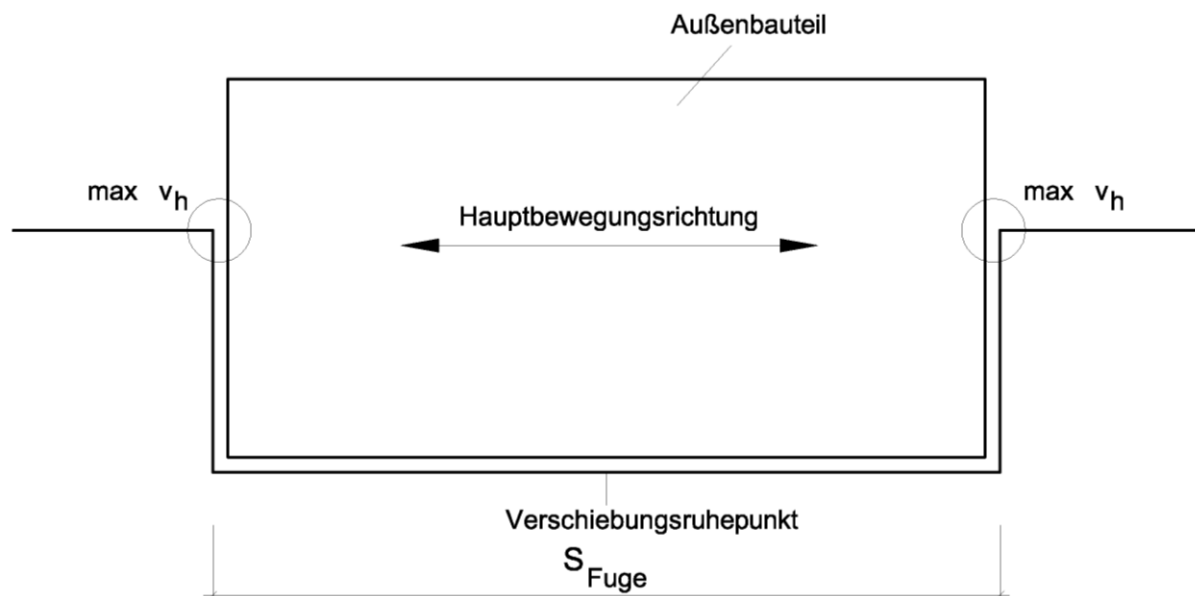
Einbausituation mit Lagerung an gegenüberliegenden Rändern
